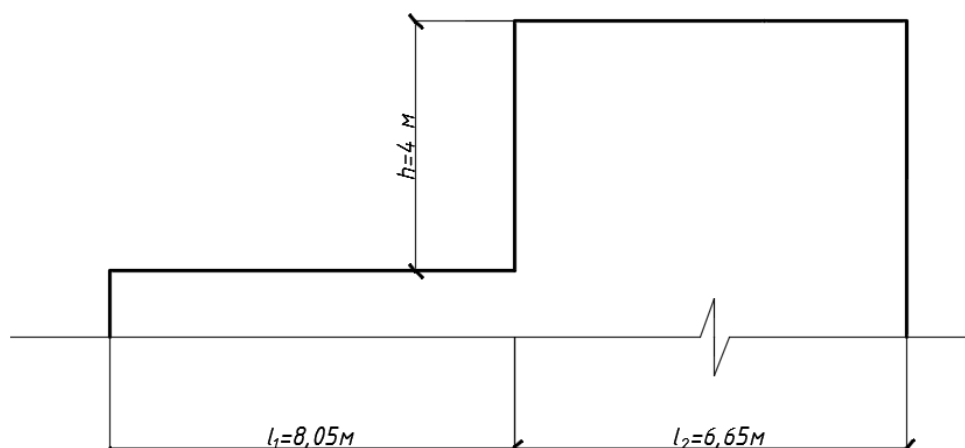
К расчету снеговой нагрузки на покрытие в зоне выхода на кровлю
